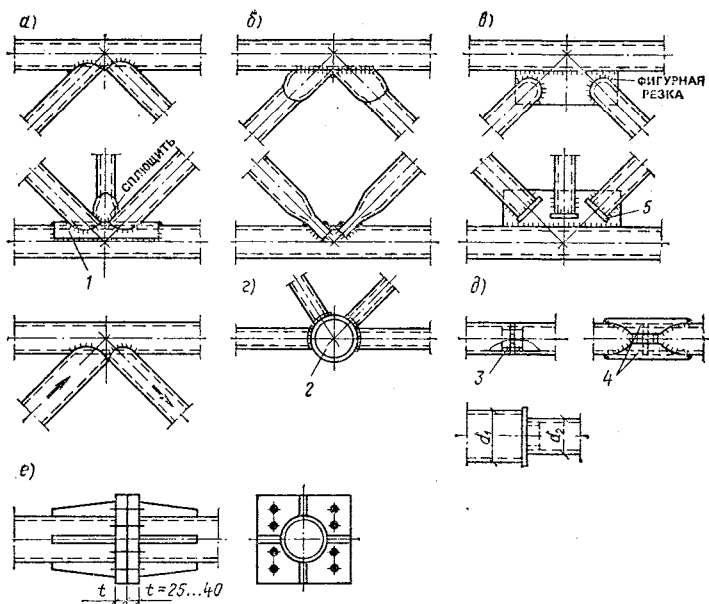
Типы сопряжений трубчатых стержней в узлах ферм
